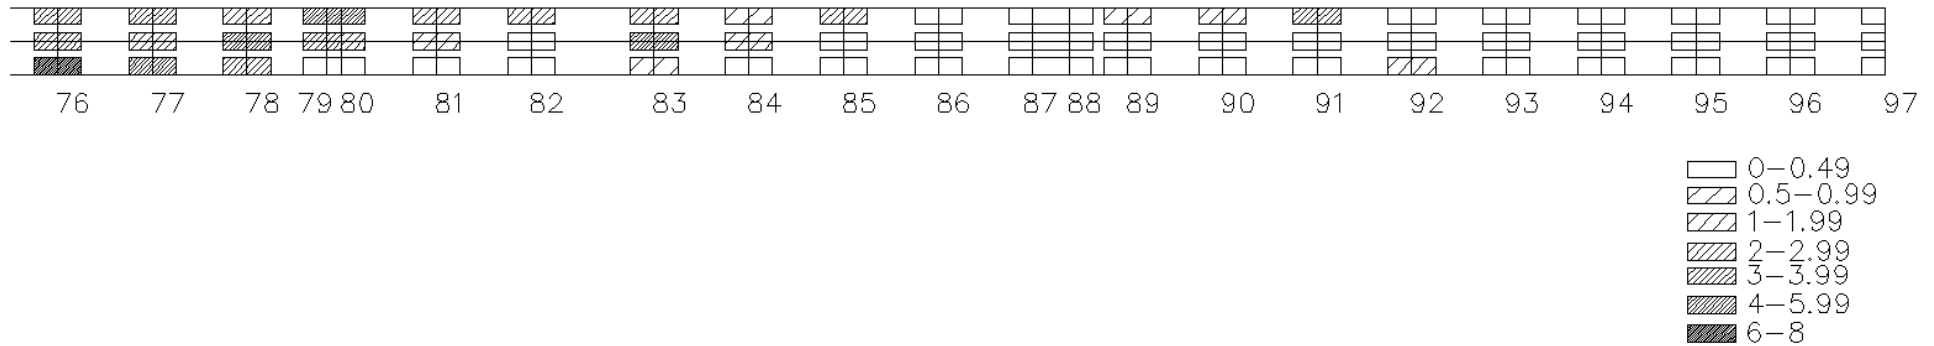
Frästiefen bei kubischer Splinefunktion und Verfahrensplan Typ C, Grundriss, Stationen 76-97
